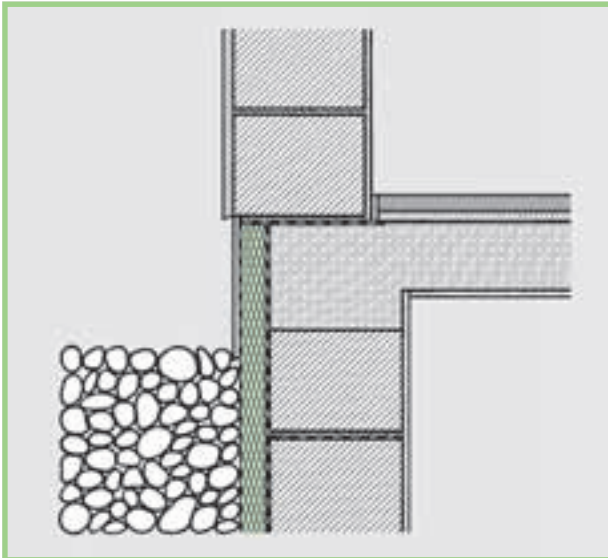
Zoccolo, isolamento perimetrale con muro isolato termicamente.
